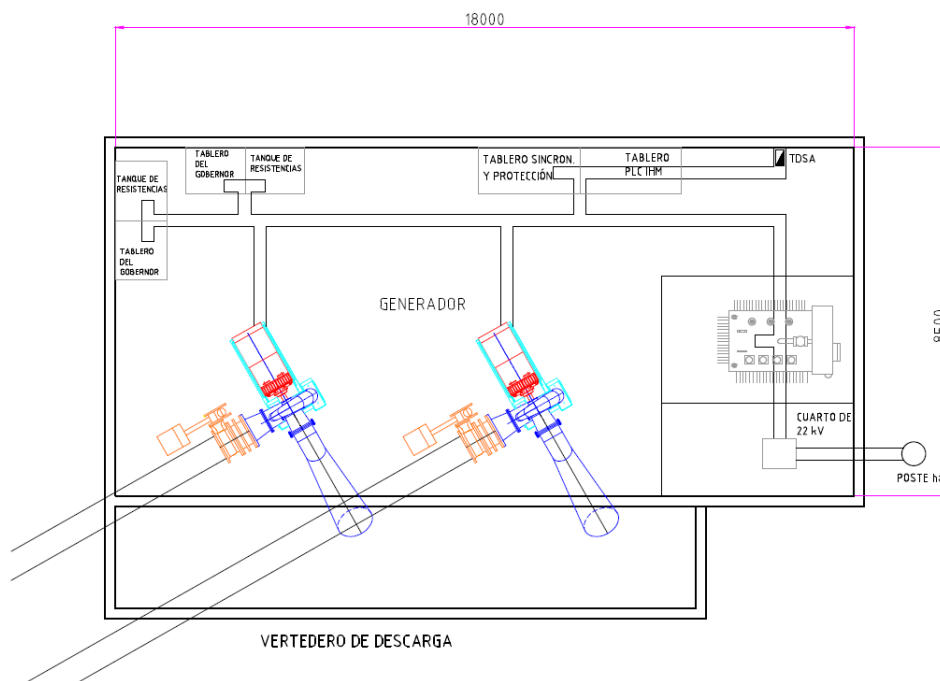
Plano preliminar de la casa de máquinas
